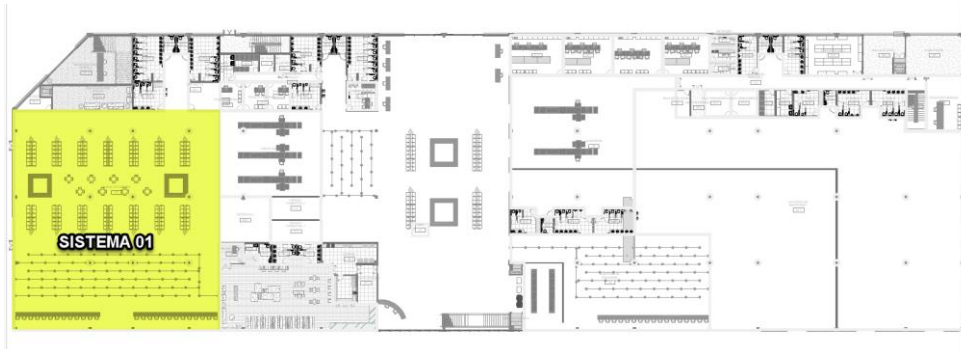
Sistema 01 (Pavimento Térreo – Lado Oeste)
